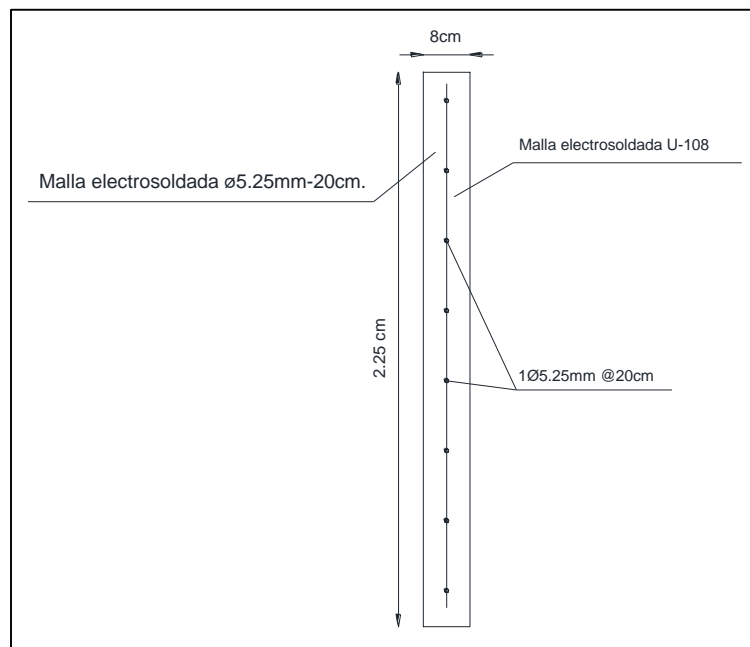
Esquema de sección longitudinal del muro portante de hormigón diseñado.
